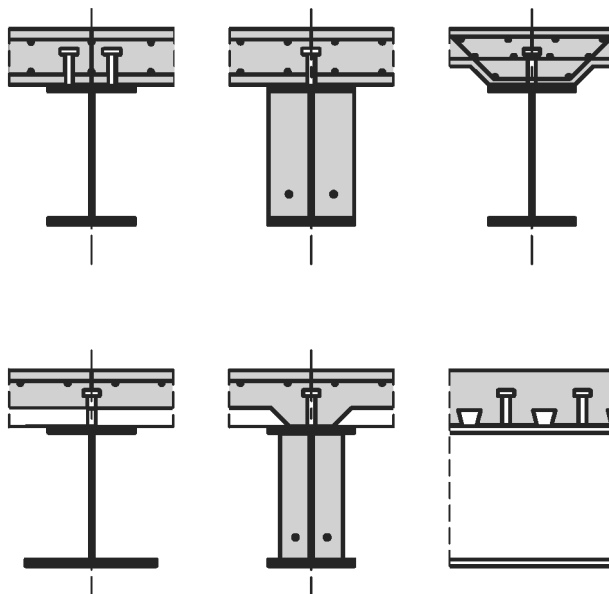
Secciones transversales típicas de vigas mixtas
